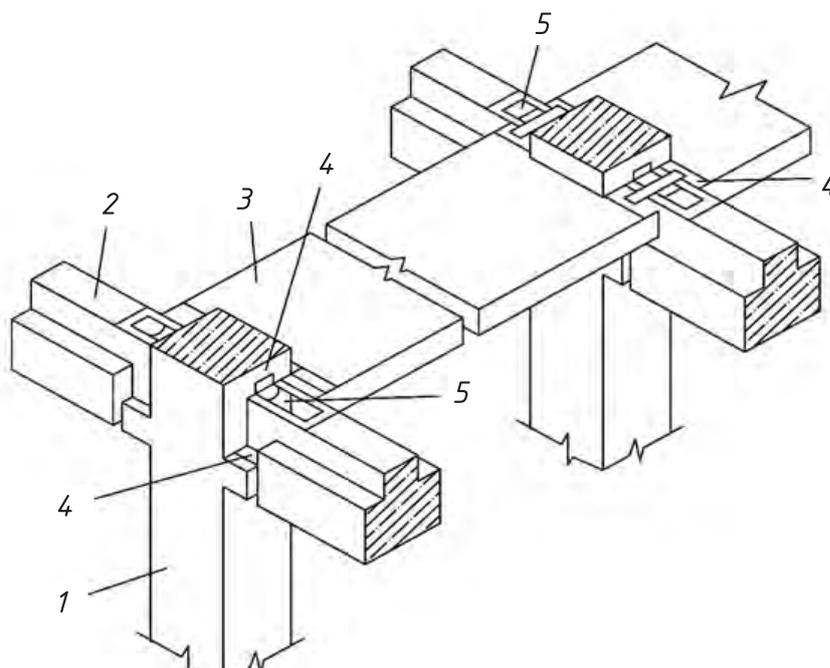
Узел опирания ригеля на колонну в унифицированном каркасе. Общий вид: 1 — колонна; 2 — ригель; 3 — настил-распорка; 5 — верхняя накладка
